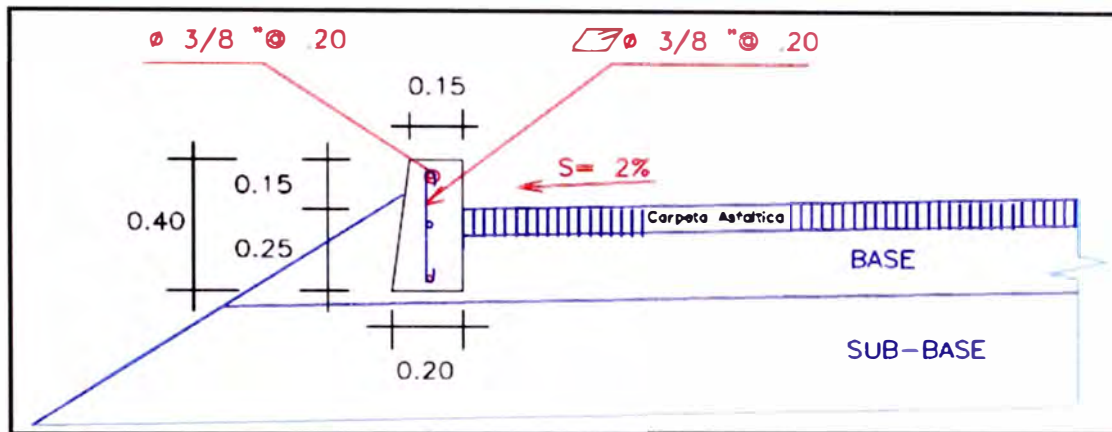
Detalle típico de bordillo de concreto armado
